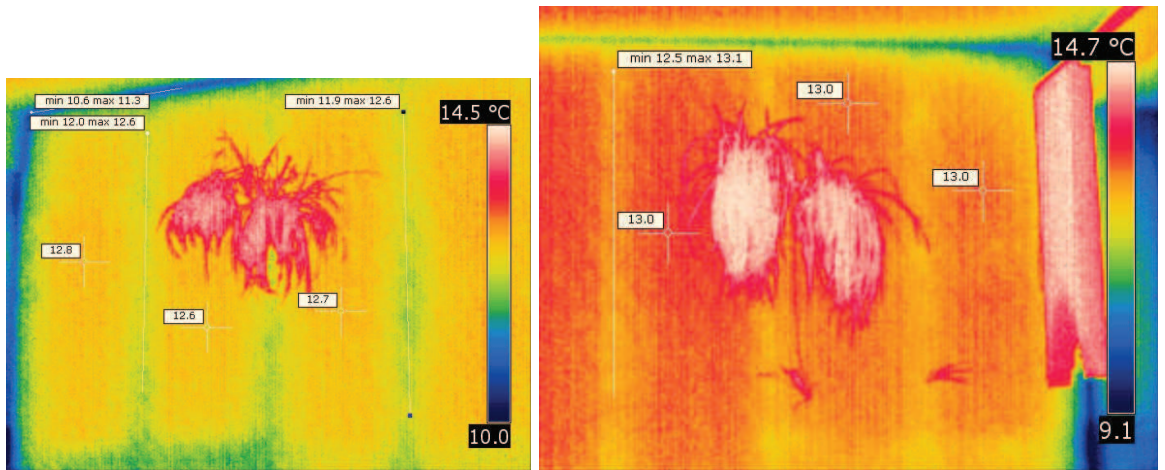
Стена помещения №214 (учебный класс), западный фасад
